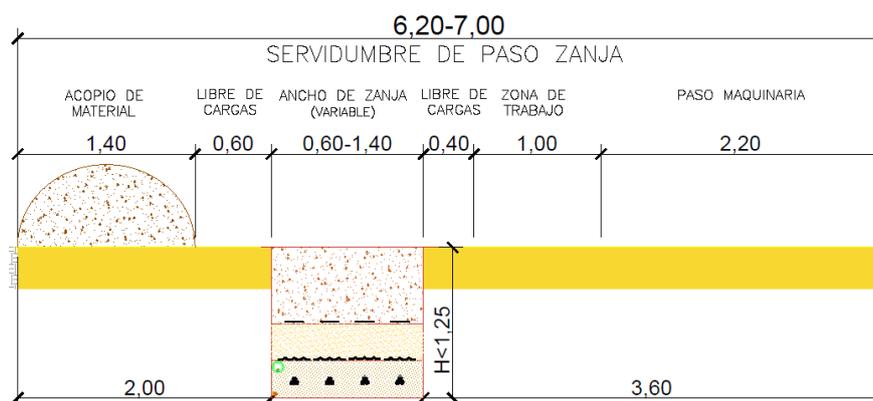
Sección transversal de detalle de servidumbre de zanja
